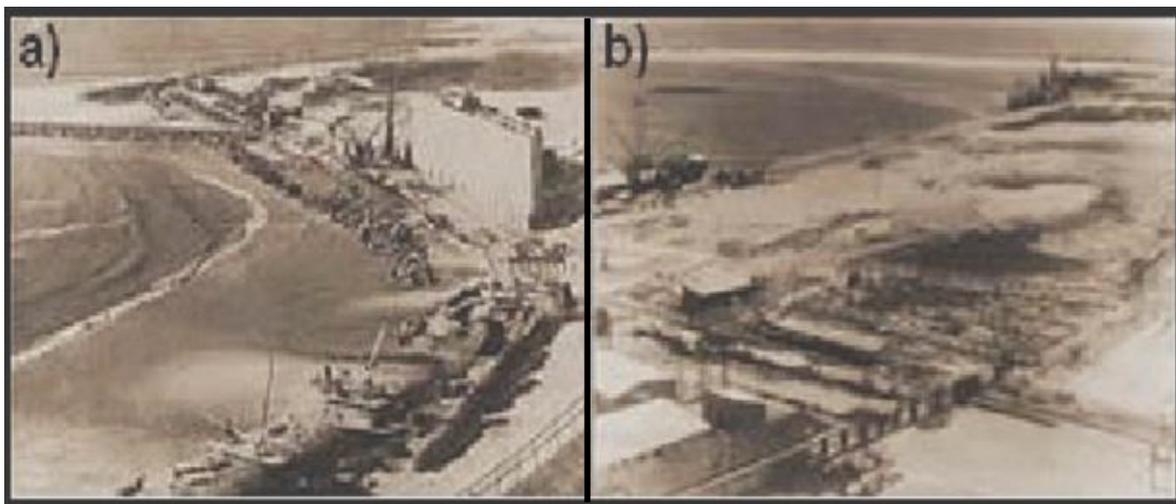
Construção das instalações do novo porto em Fortaleza, entre 1952 – 1964. a) Construção do Porto do Mucuripe, 1952. b) Construção da Estação de Passageiros, 1964. Fonte: Docas do Ceará (2002)
